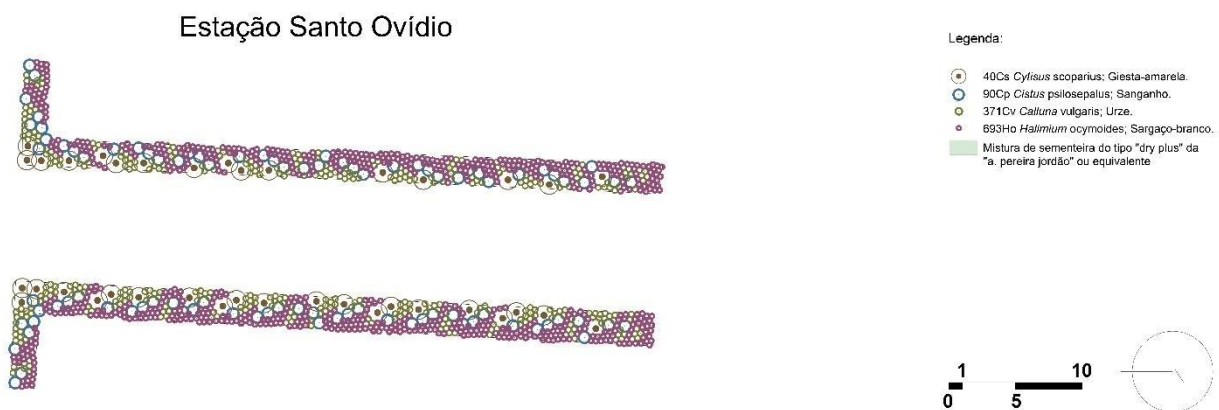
Plano de plantação estação Santo Ovídio (Fonte: Autor)
